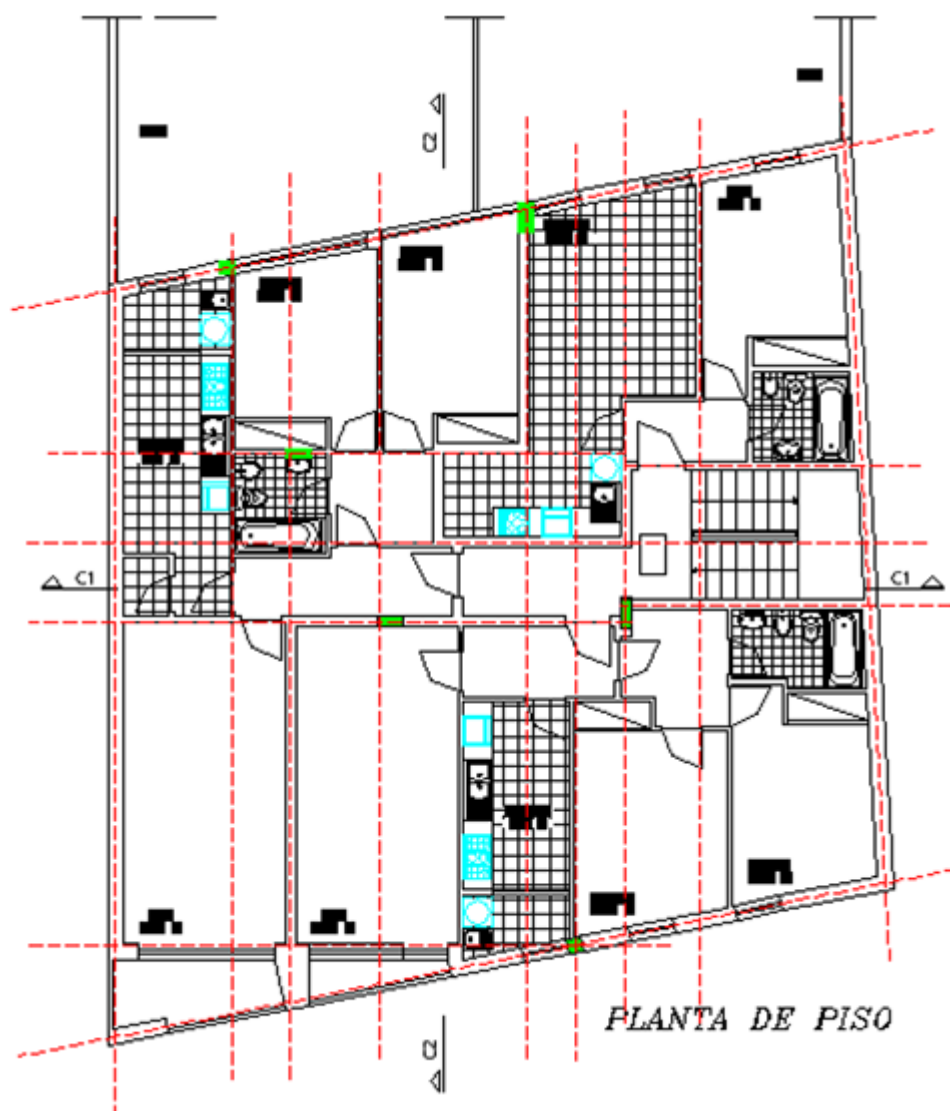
Sobre posição esboço arquiteto com planta dos pisos (sem escala)
